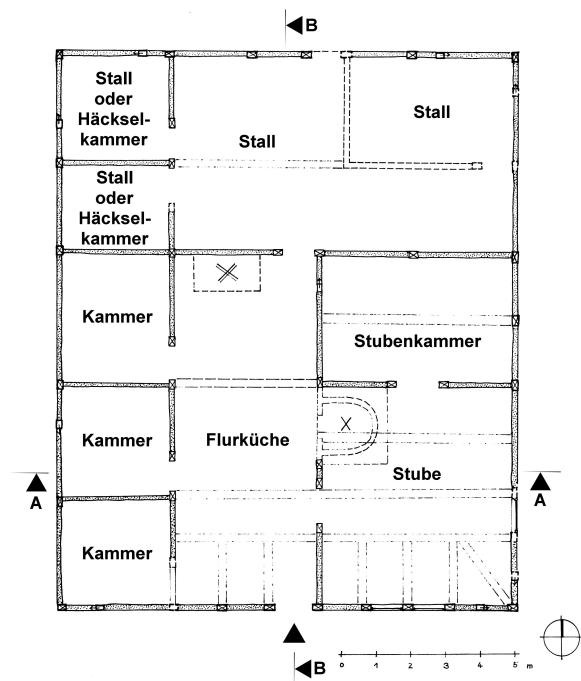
Manker, Dorfstraße 58, Erdgeschoss-Grundriss. Rekonstruktion des Erbauungszustands von 1698. Zeichnung: Katja Laudel
